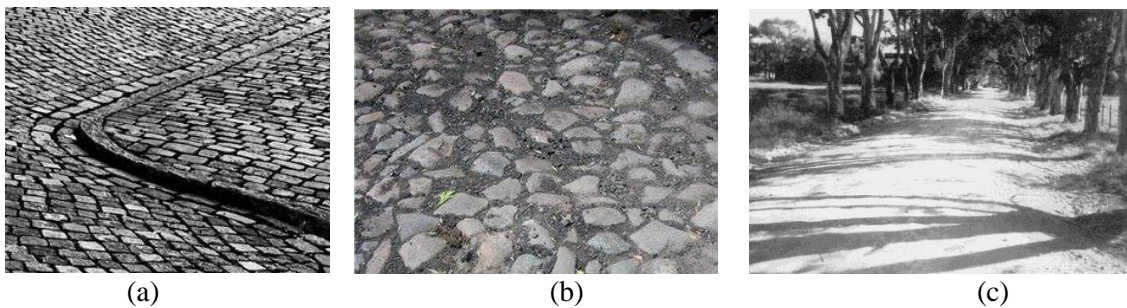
Otros tipos de pavimentos (a) adoquines, (b) empedrados, (c) suelo-cemento.
